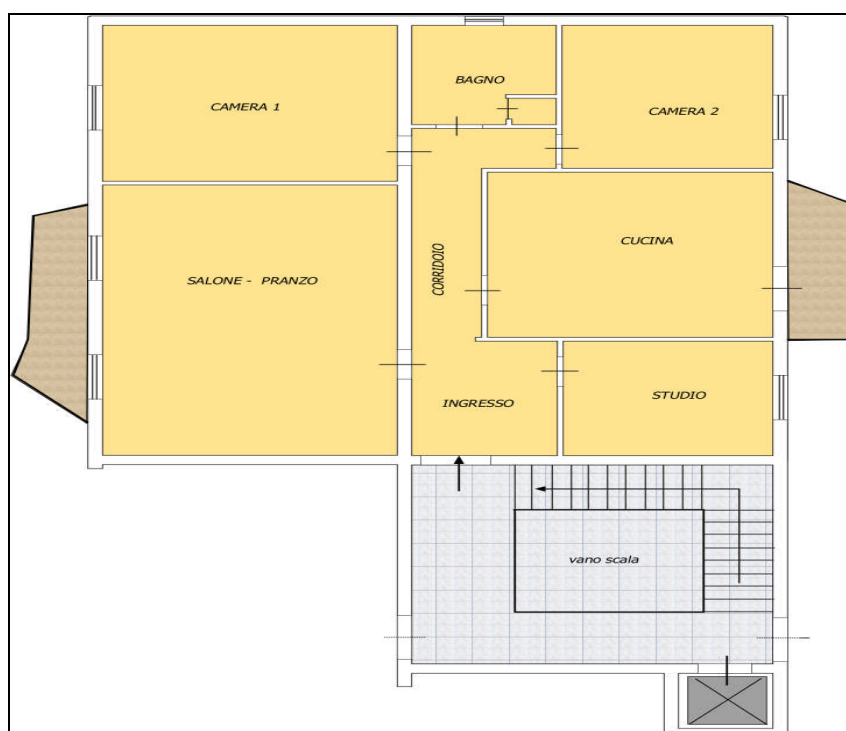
ELABORATO PLANIMETRICO APPARTAMENTO
